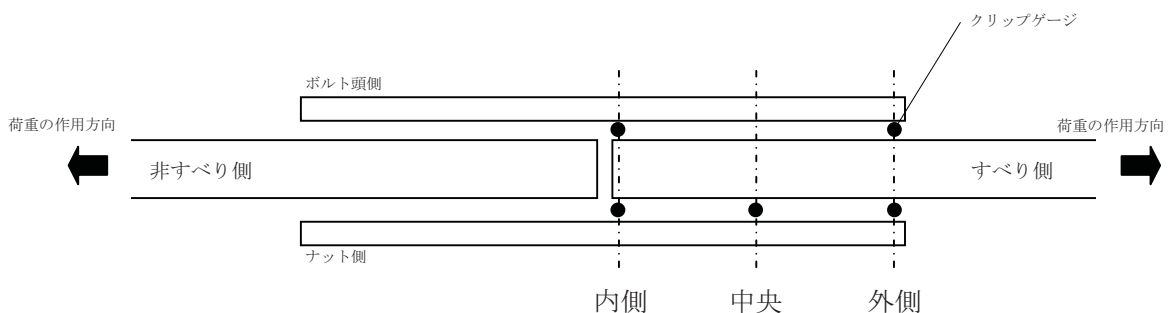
計測位置の名称 (フィラープレートを使用しない試験体)
